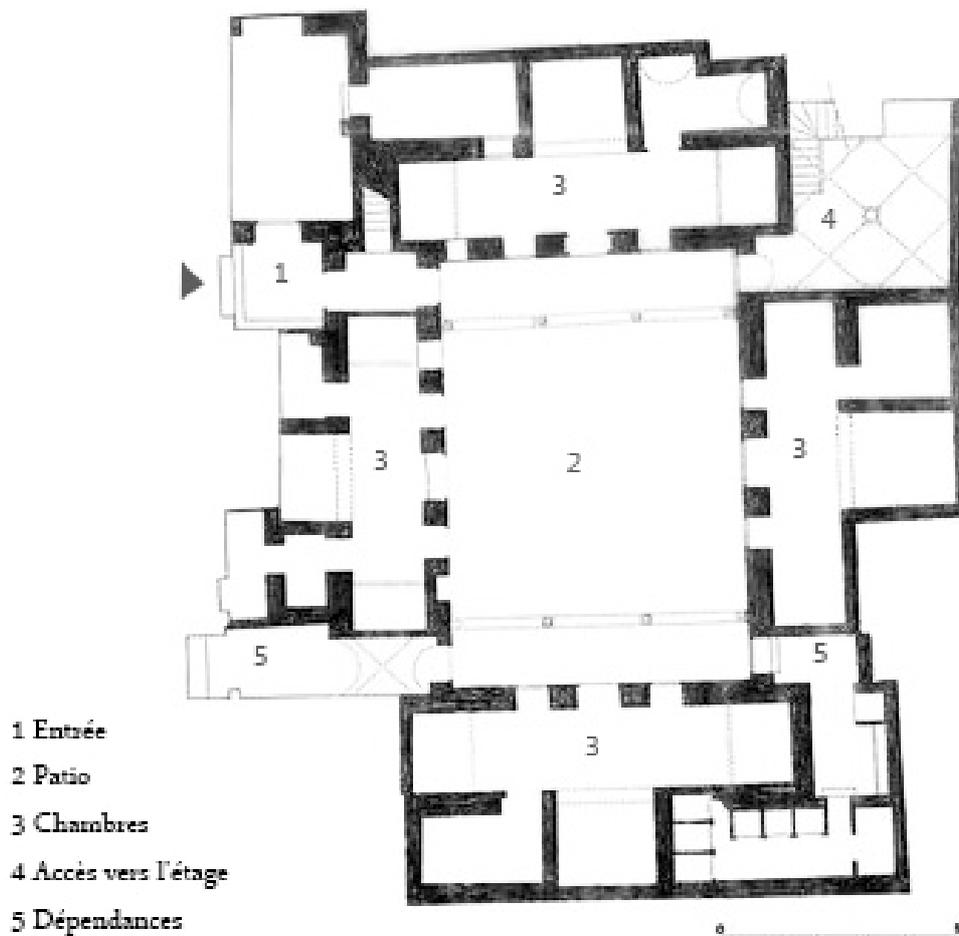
Plan RDC du Dar El Jaziri (Source INP)
